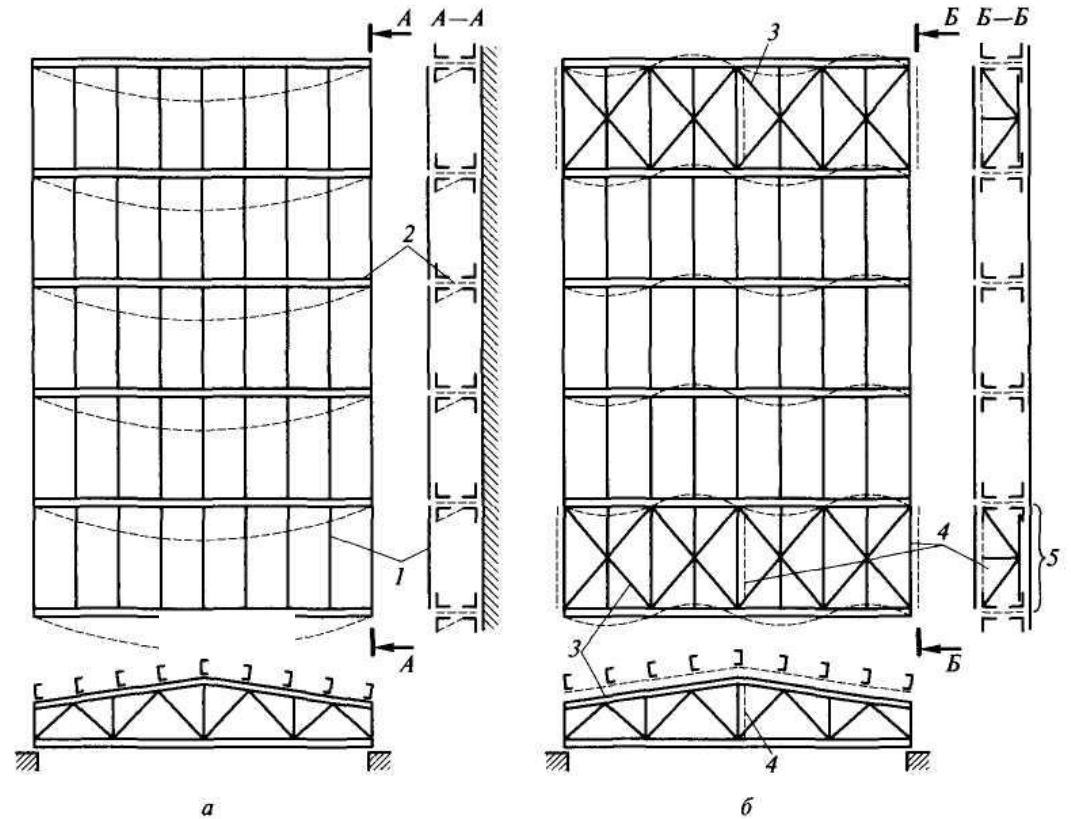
Связи, обеспечивающие устойчивость стропильных ферм:
